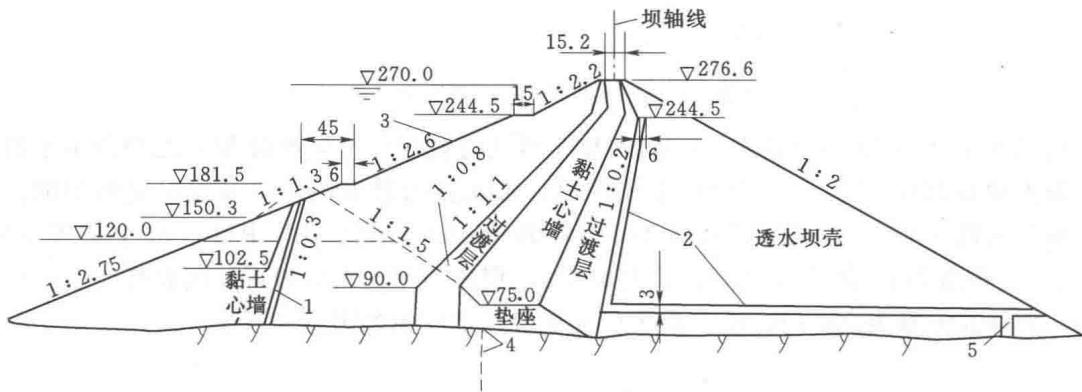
奥罗维尔斜心墙坝断面图 (单位: m)
